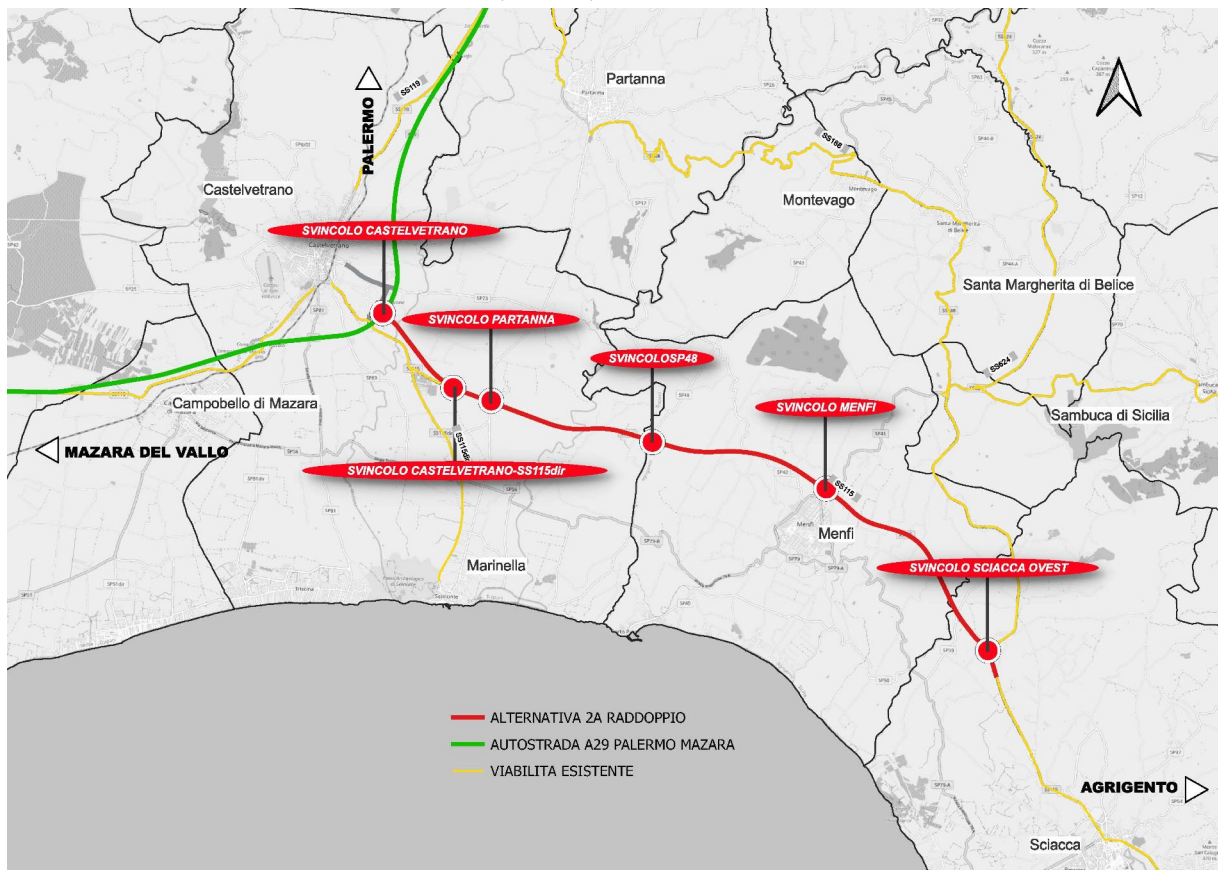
Planimetria e profilo di progetto – Alternativa 2A
